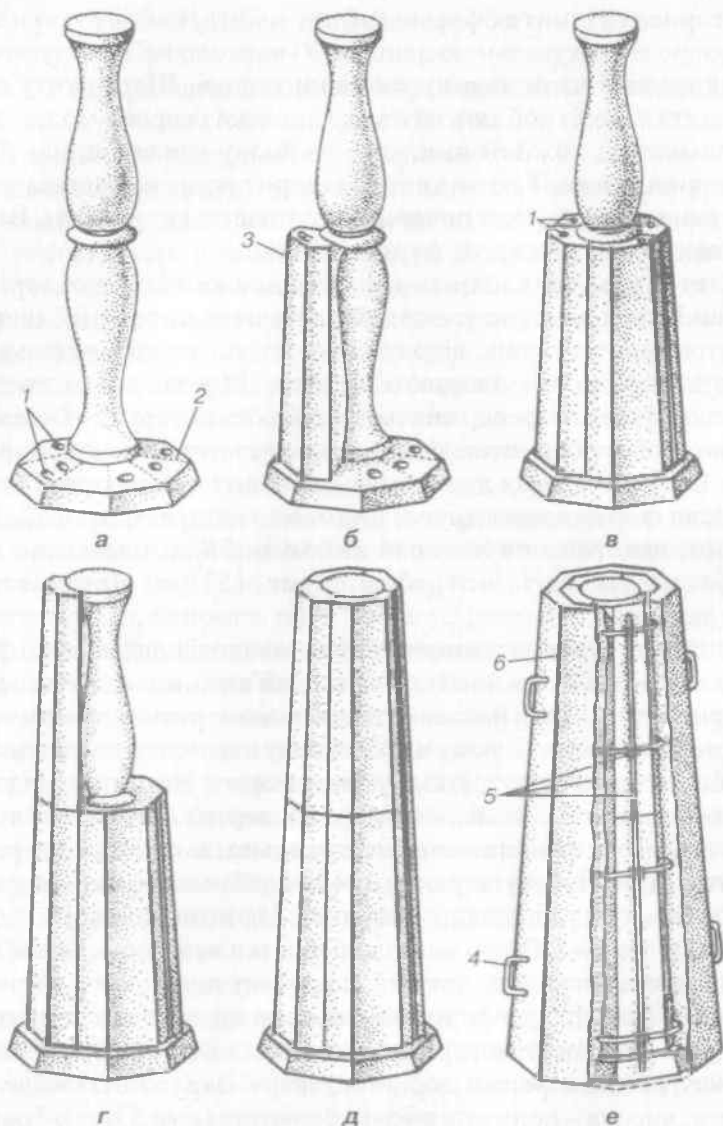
Кускова форма для виготовлення цементної баліасини:
